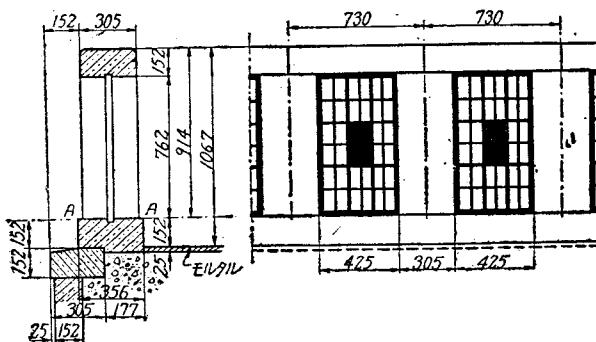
八重洲橋高ラン Fig.11 Railing of Yaesu br.
